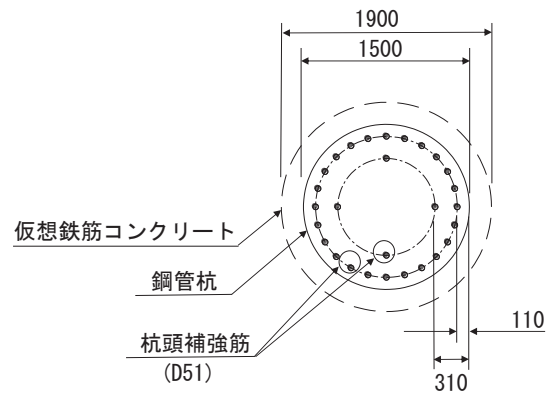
杭頭配筋概要図 (鋼桁 3)
